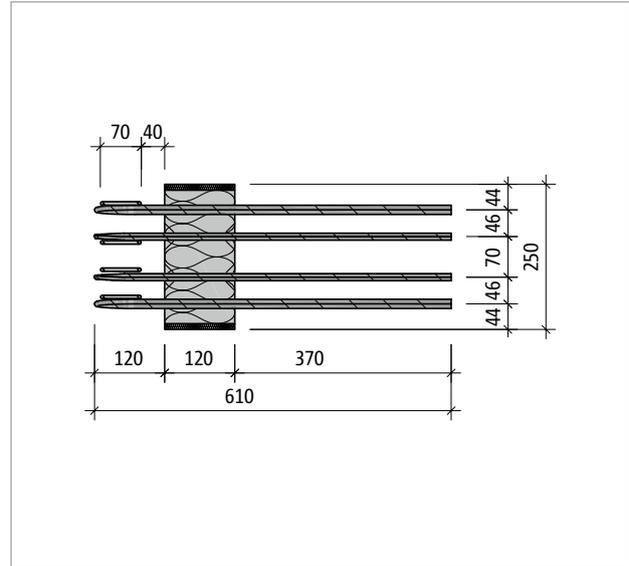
Schöck Isokorb® XT Typ F: Produktgrundriss
